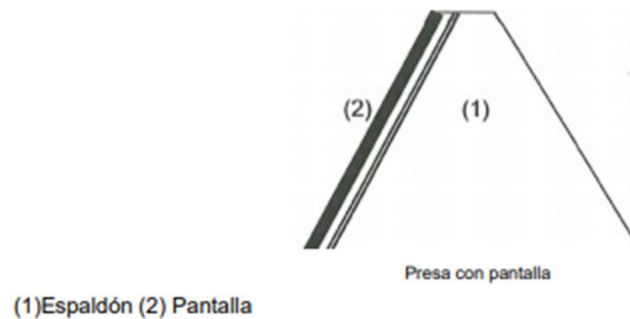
Perfil de presa de escollera con pantalla de hormigón.
